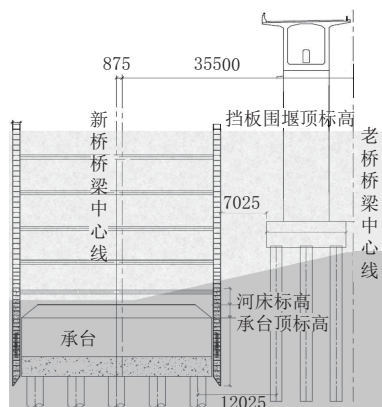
新桥22#墩与老桥主桥2#桥墩位置关系立面图(单位:mm)
